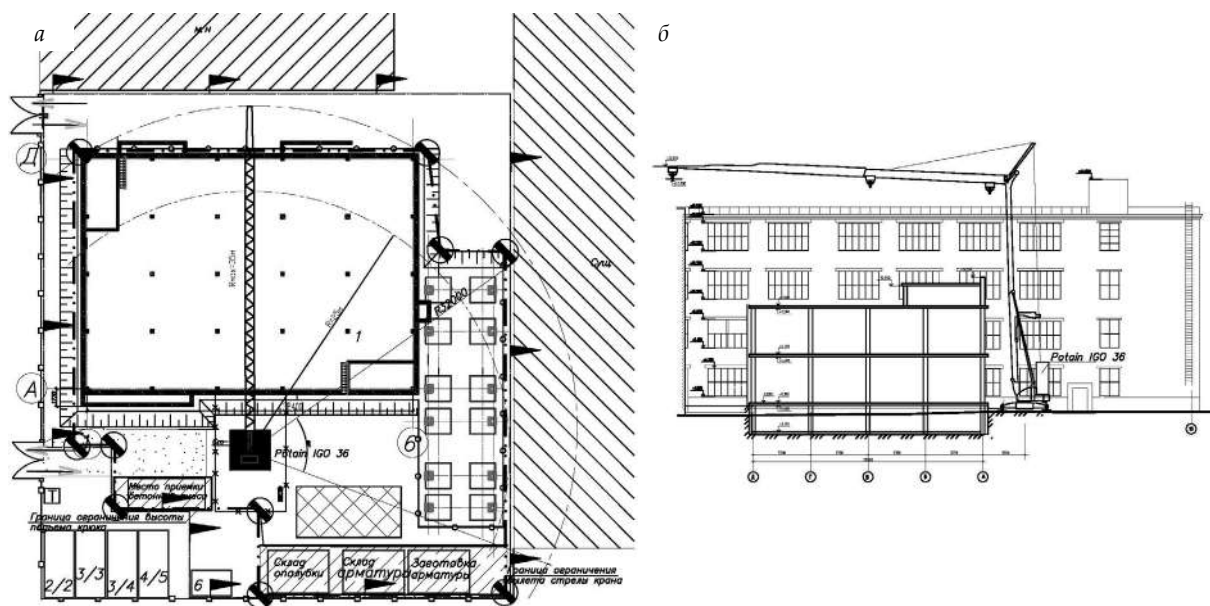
Расчетная схема установки быстромонтируемого крана при возведении корпуса микрoeлектронных технологий: а – схема-план; б – схема-разрез
